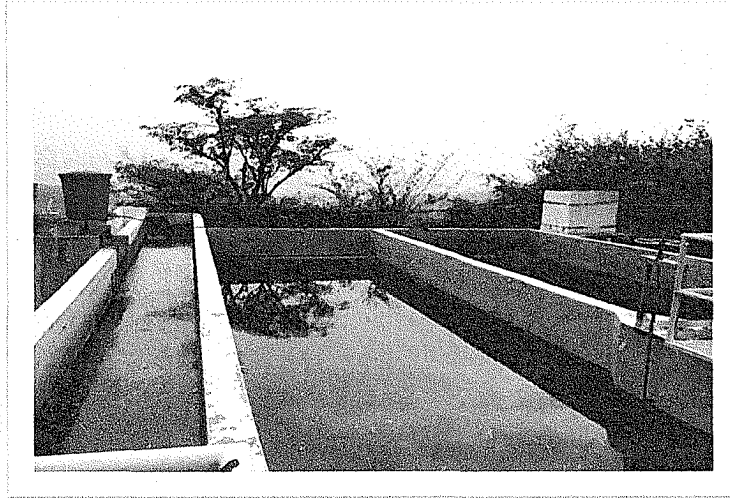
Vista de las instalaciones de la Planta Potabilizadora El Molino
